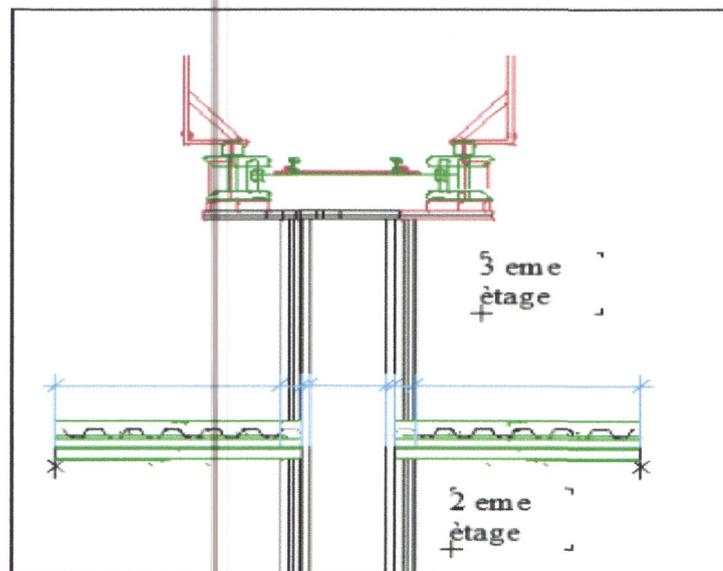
Détail d'assemblage voie roulante du monorail / pile circulaire en béton / planche des étages
